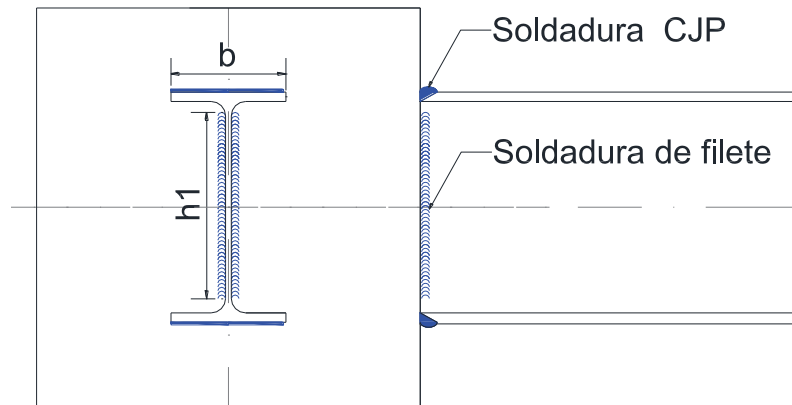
Esquema de conexión Viga IPE 330 - Columna
